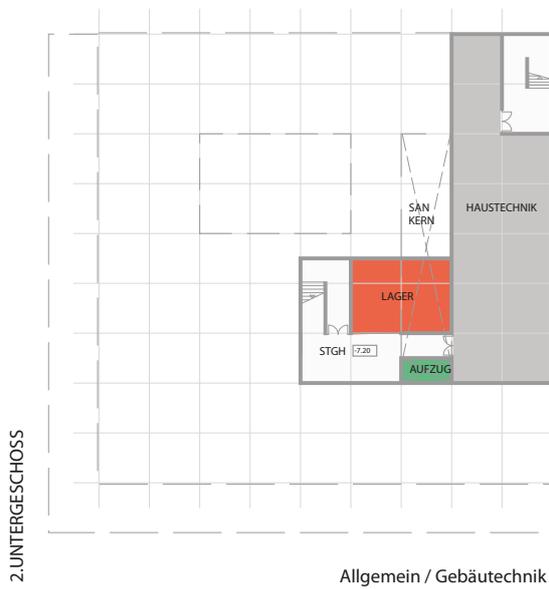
Vorentwurf _ Grundriss 2.UG
